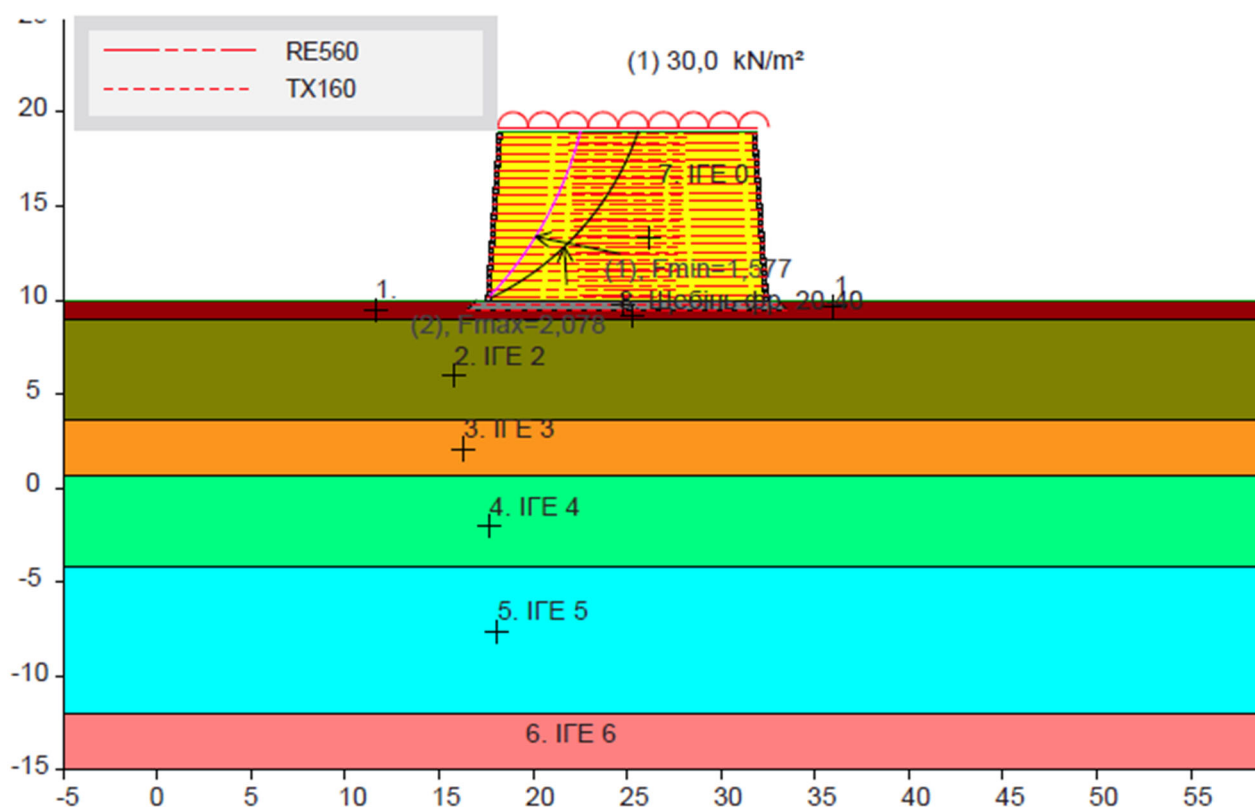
Розрахункова схема армогрунтової конструкції зі стабілізуючим геоматрасом (метод Бішопа, статичний аналіз) (TENSAR SLOPE)
